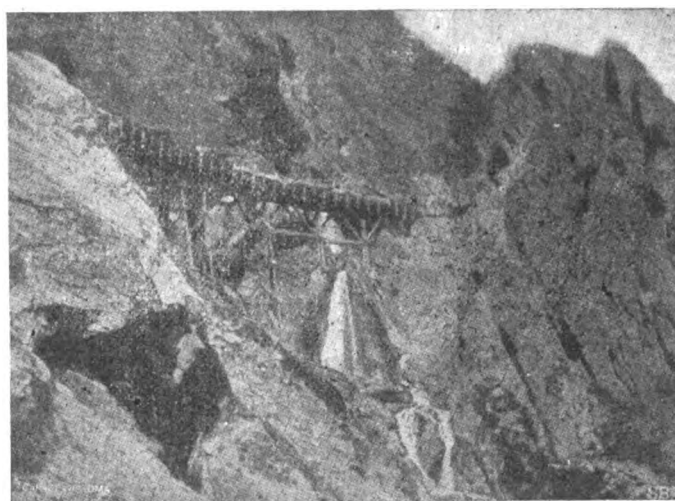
Ponte sulla linea di servizio della rampa sud, attraverso il torrente Baltschieder. - Vista.
